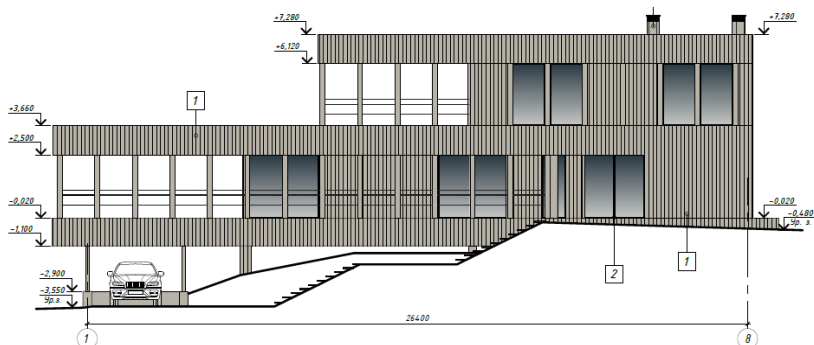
Фасад жилого дома по оси «А» в осях «1-8»
